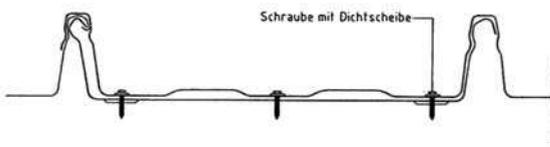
Festpunktausführungen für Klemmfalzprofile
